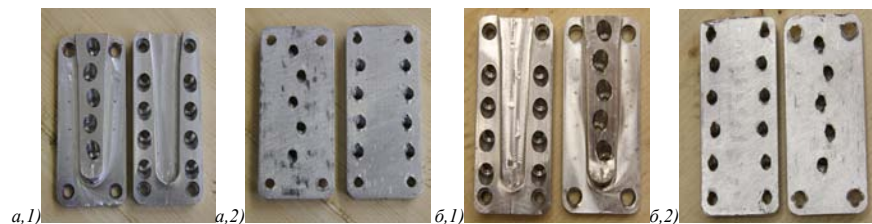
Виды разрушения металлических накладок в деревянных конструкциях: а,1)-а,2) стеновой панели и балки из *CLT*; б,1)-б,2) стеновой панели из *CLT* и балки из *LVL
